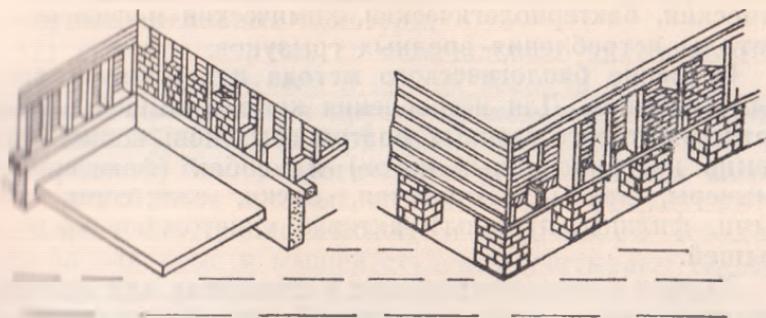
Укладка фундаментов и полов в крысонепроницаемых помещениях.
